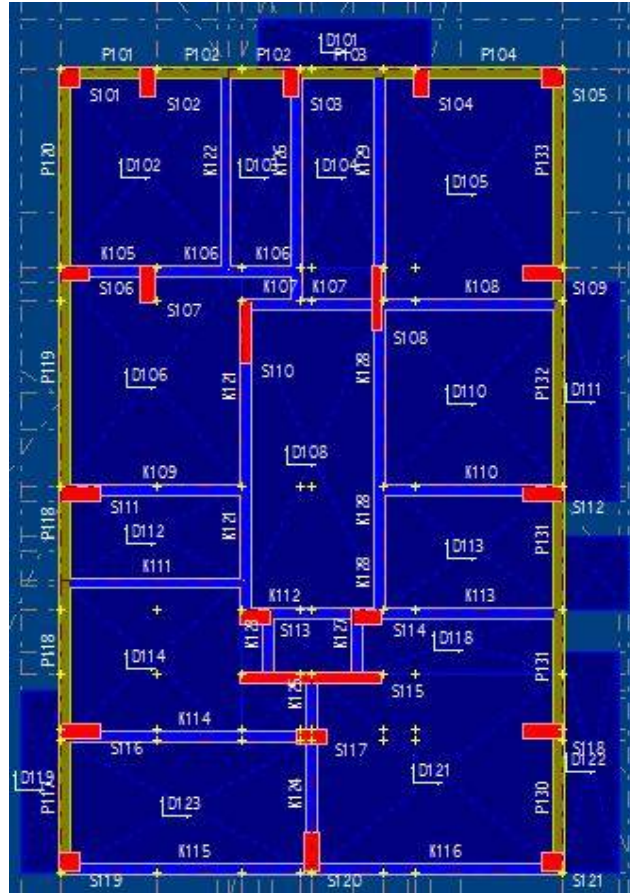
(11) Nolu bina modelleme kat planı
